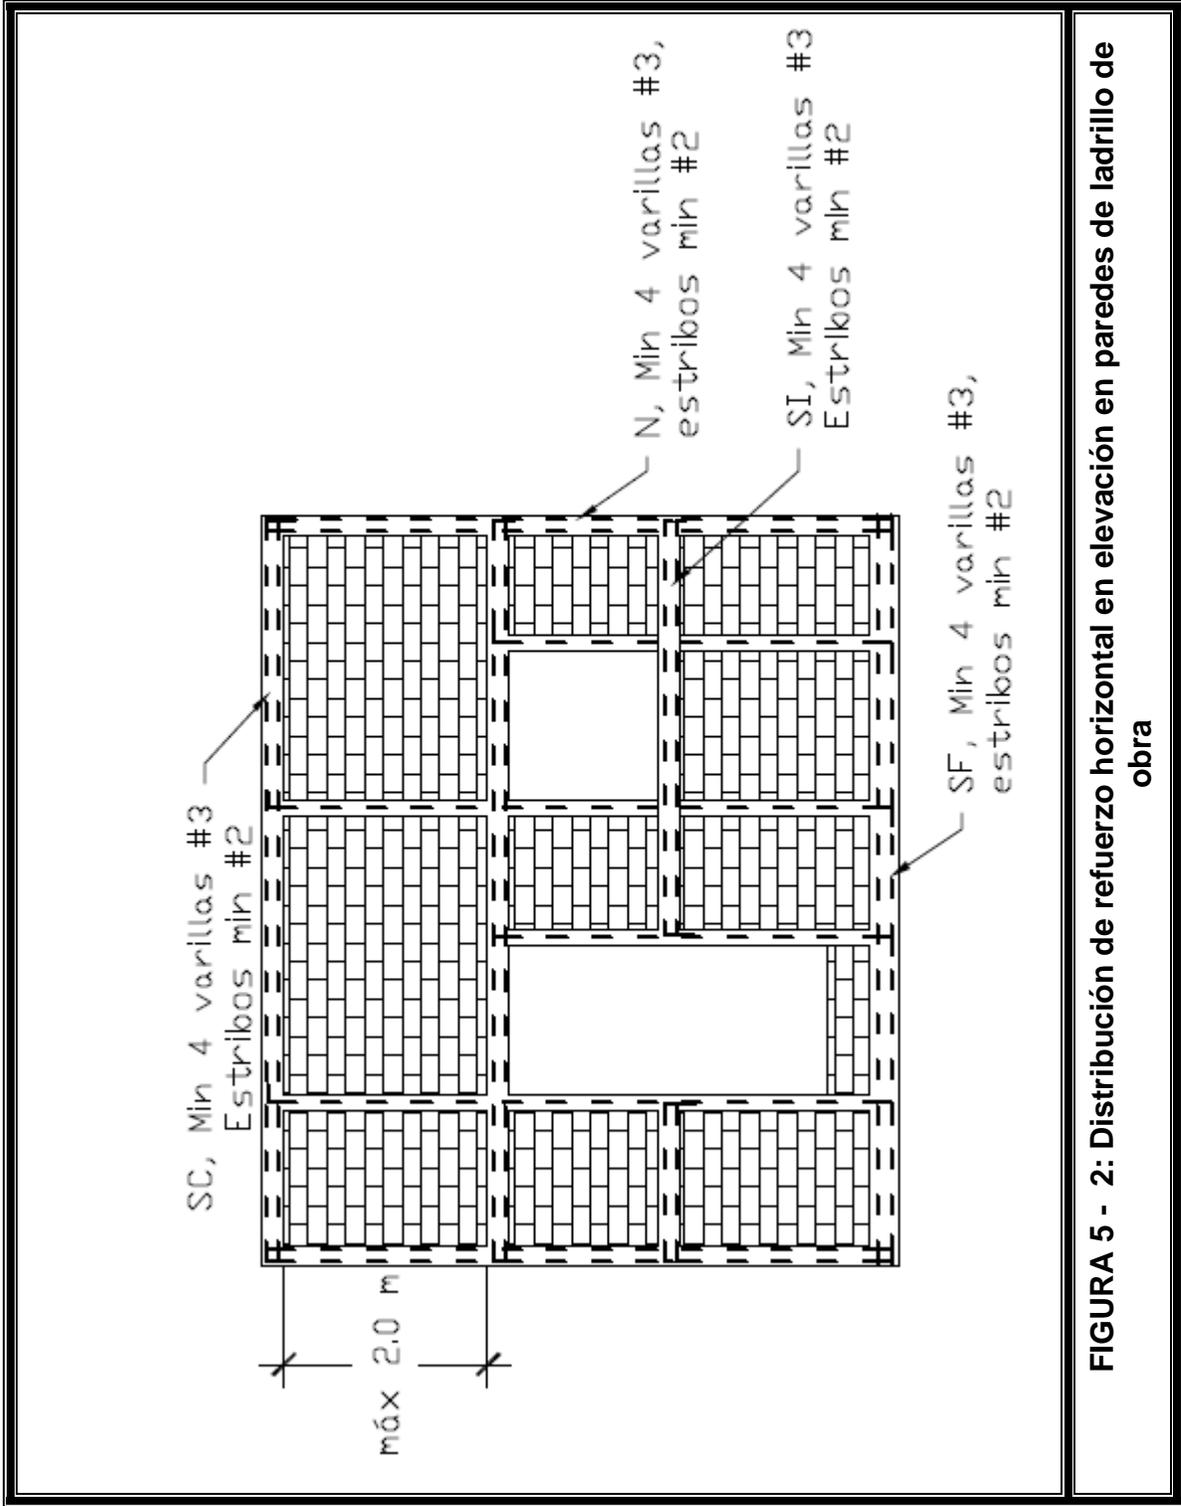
2: Distribución de refuerzo horizontal en elevación en paredes de ladrillo de obra
